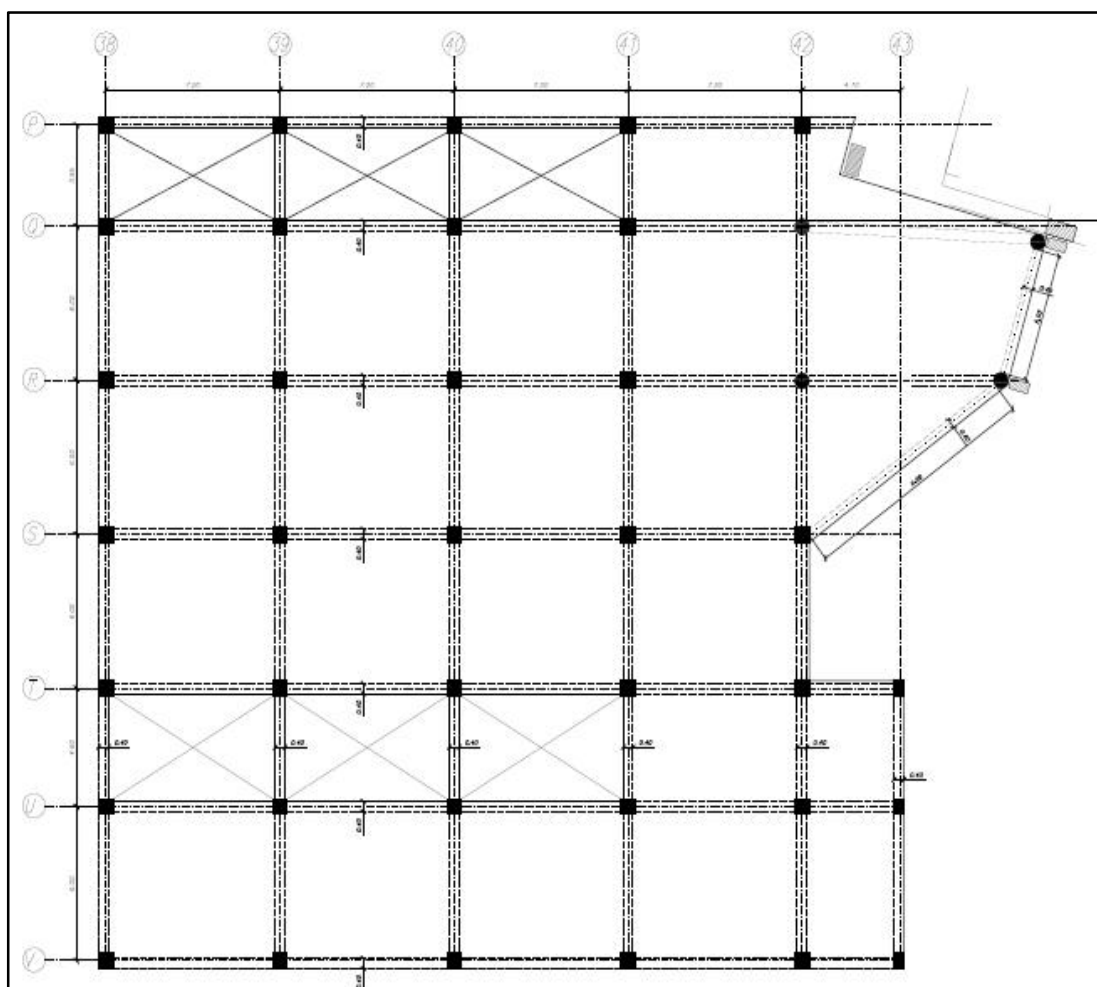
Planta estructural N+3.96, Consulta Externa I
